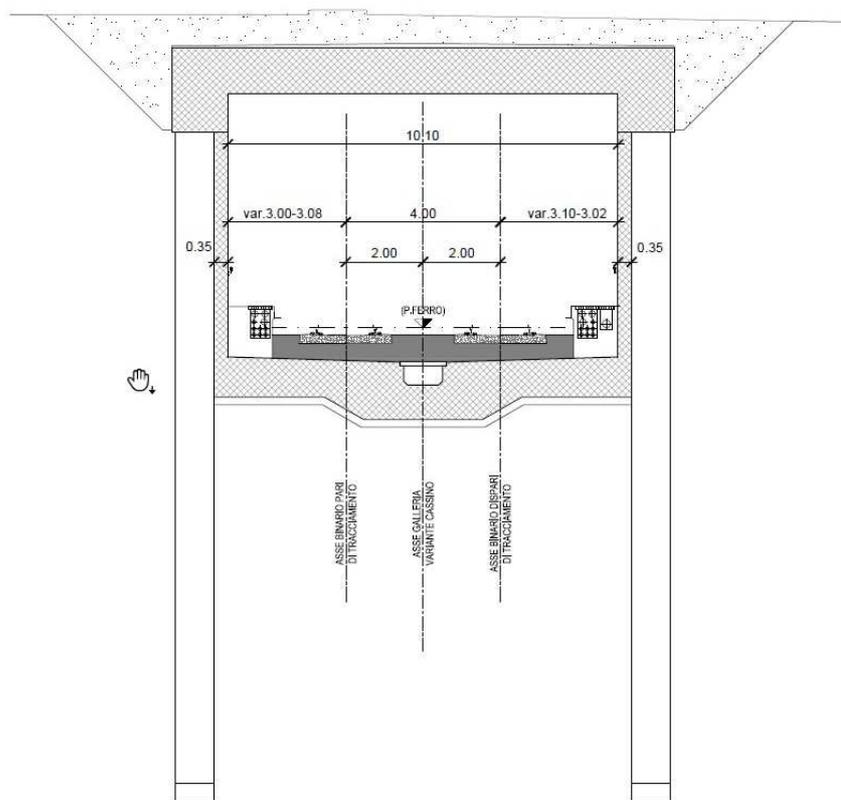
sezione trasversale in galleria: tipo B(da elaborato 1.f)
